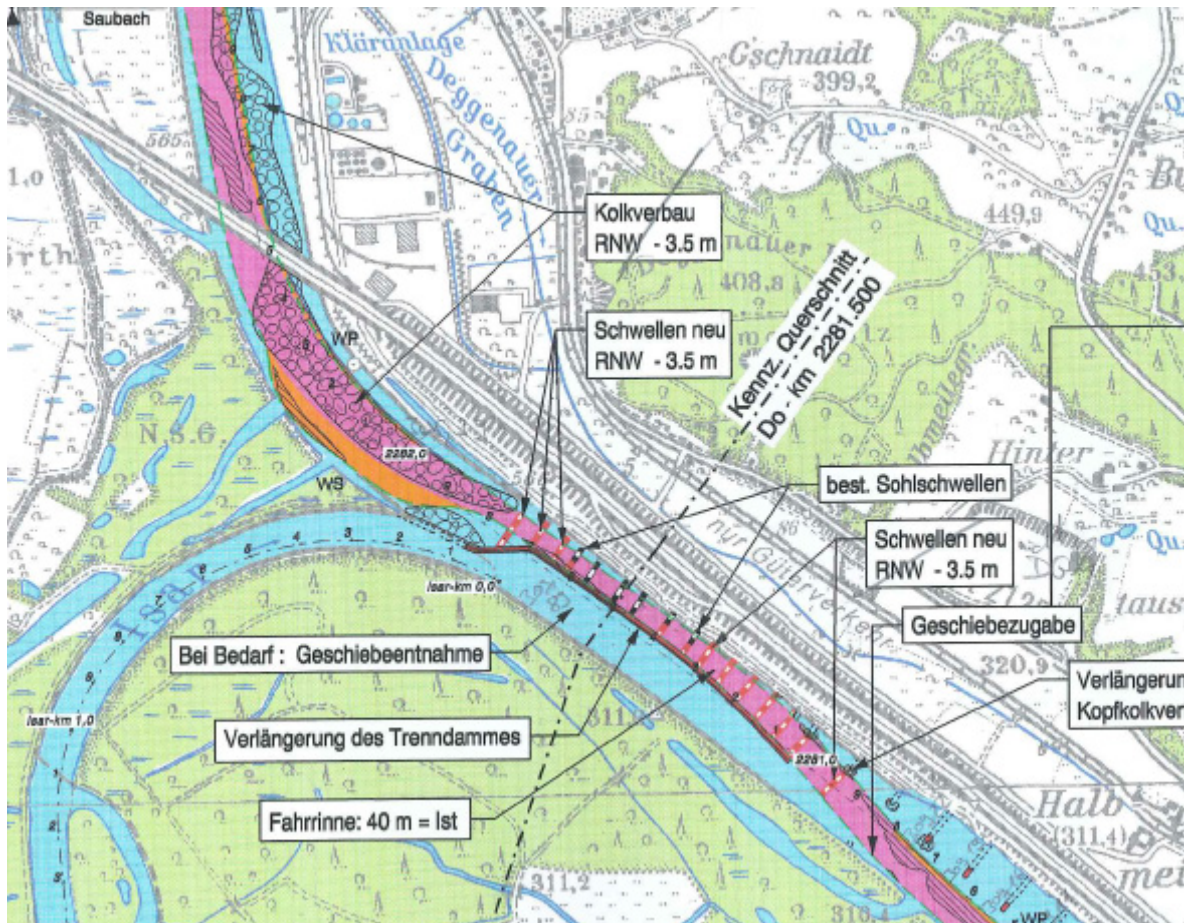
Lageplan der Baumaßnahmen der Variante A im Bereich der Isarmündung nach [B5]
